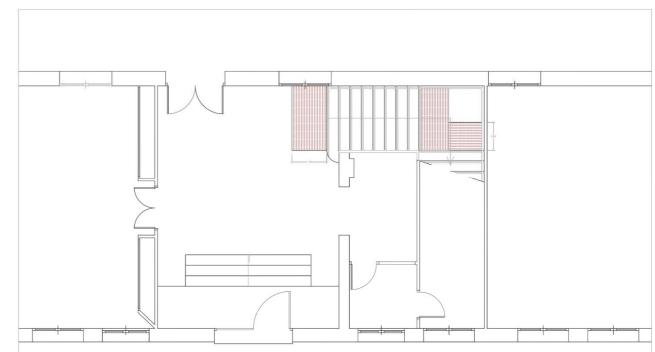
Escalera 3, Itinerario 4 Planta baja, propuesta, bandas de pavimento táctil y bandas antideslizantes.
